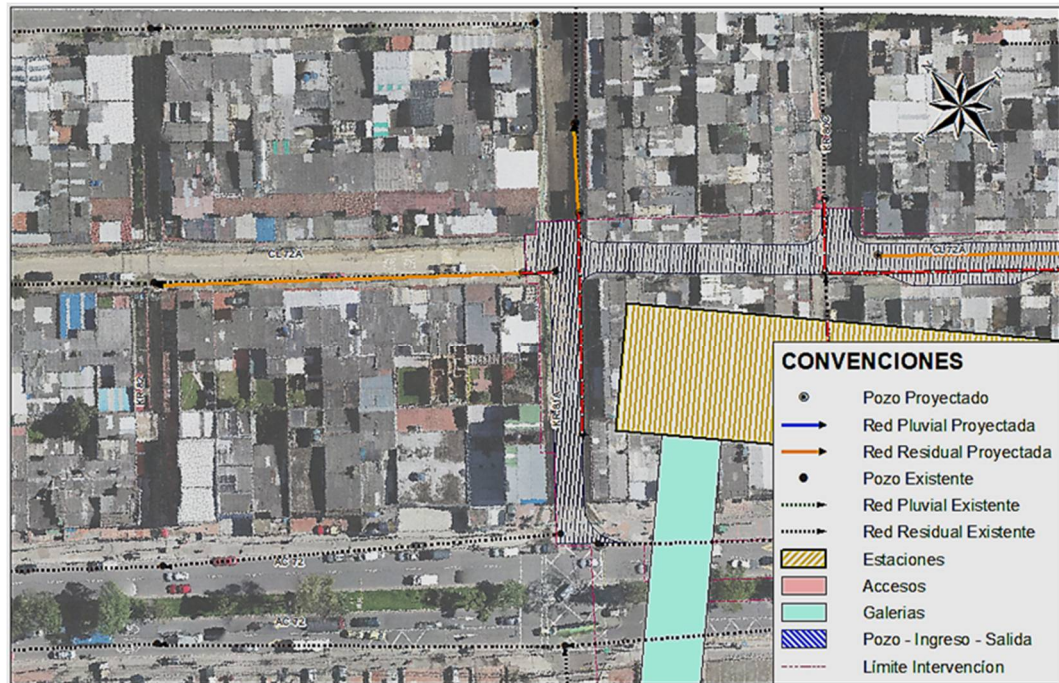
Traslado redes de alcantarillado Estación 5 Calle 72A y Carrera 81A - Red Residual.
